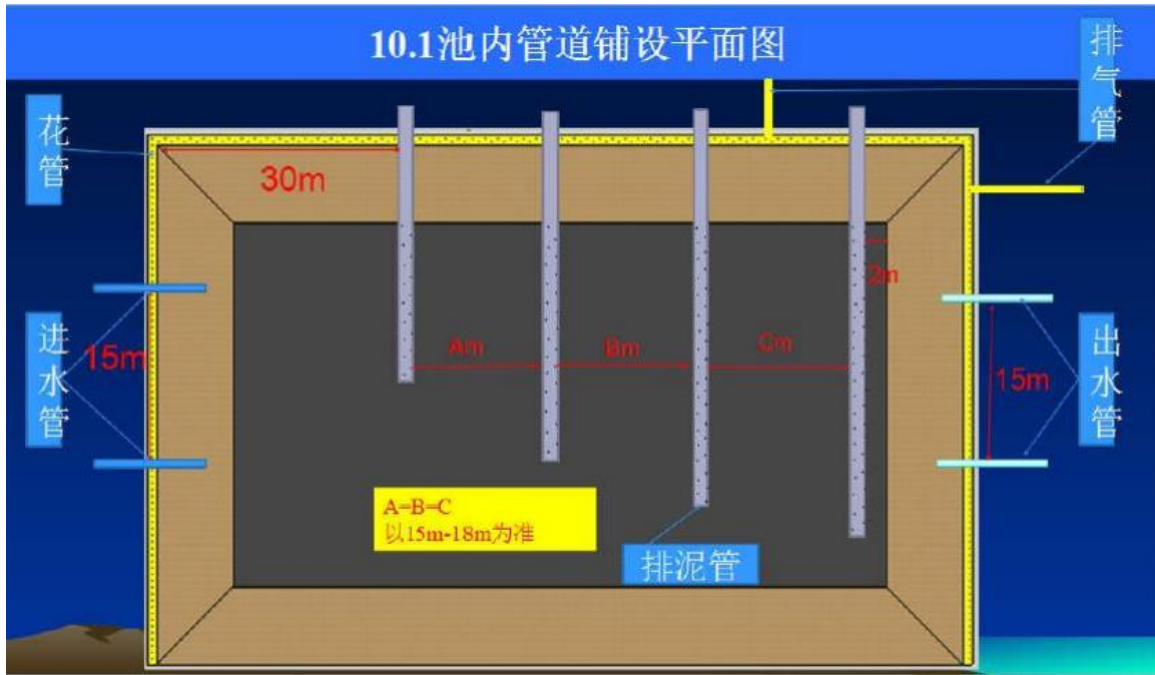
黑膜沼气池内部管道铺设平面图（仅供参考，非本项目）
